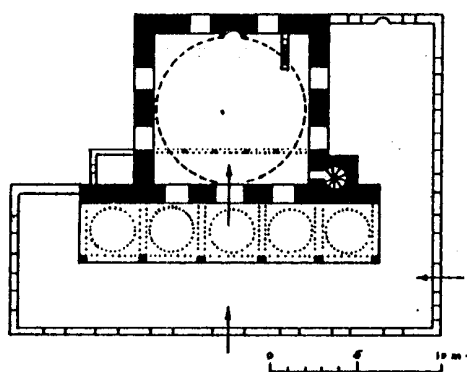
مسقط أفقي لتربة بايزيد يلدريم
